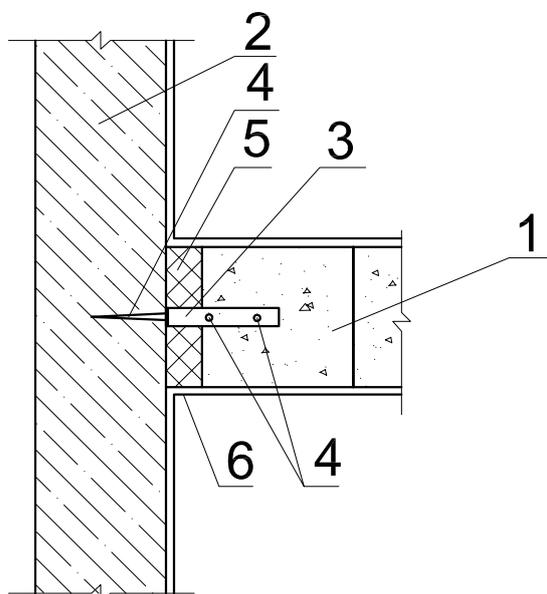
Армирование швов между газобетонными плитами ГРЭС в зоне опирания на внутреннюю стену (швы совпадают)
